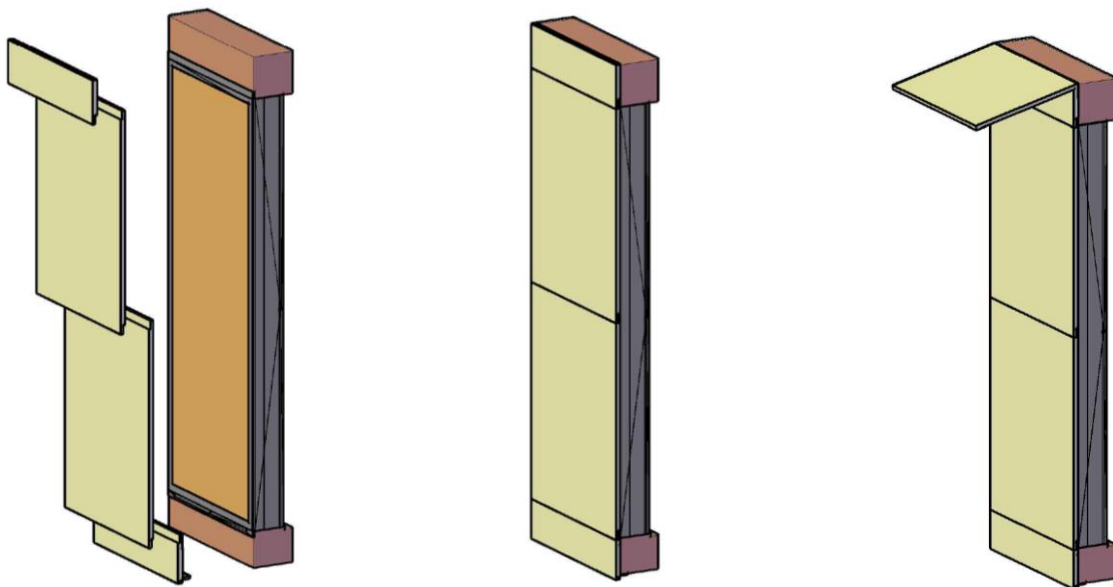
Encaixe do revestimento. Figura 66: Parede com revestimento. Figura 67: Sombreamento da fachada
